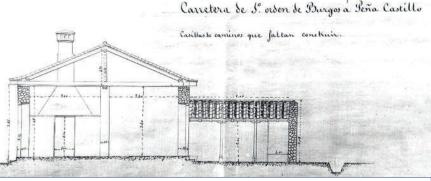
Ministerio de Fomento (1862). Proyecto de las casillas de peones camineros. Plano de alzado lateral de casilla caminera tipo a construir en la carretera Burgos-Peñacastillo (detalle). AGA 24/2.671.
